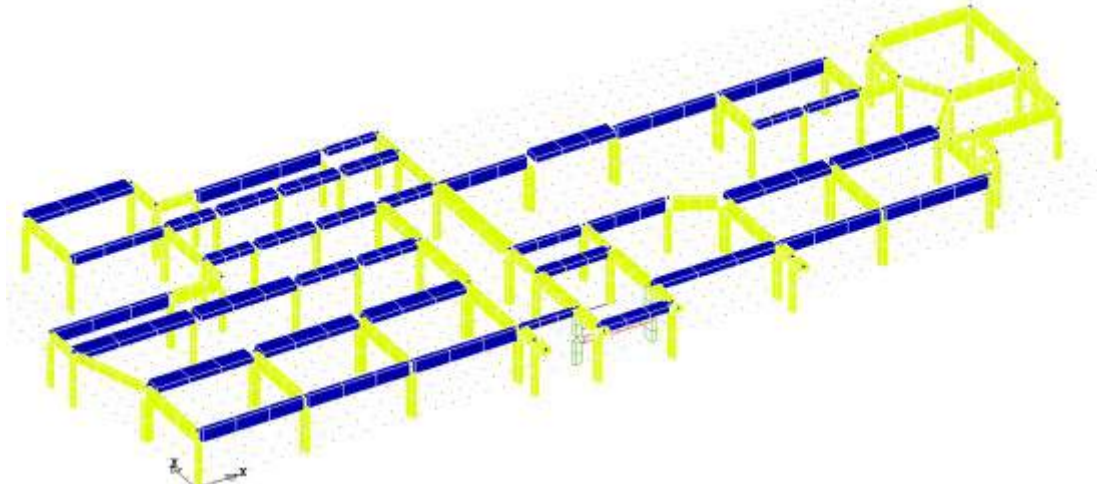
Elementi strutturali oggetto di rinforzo al piano terra (in giallo)
